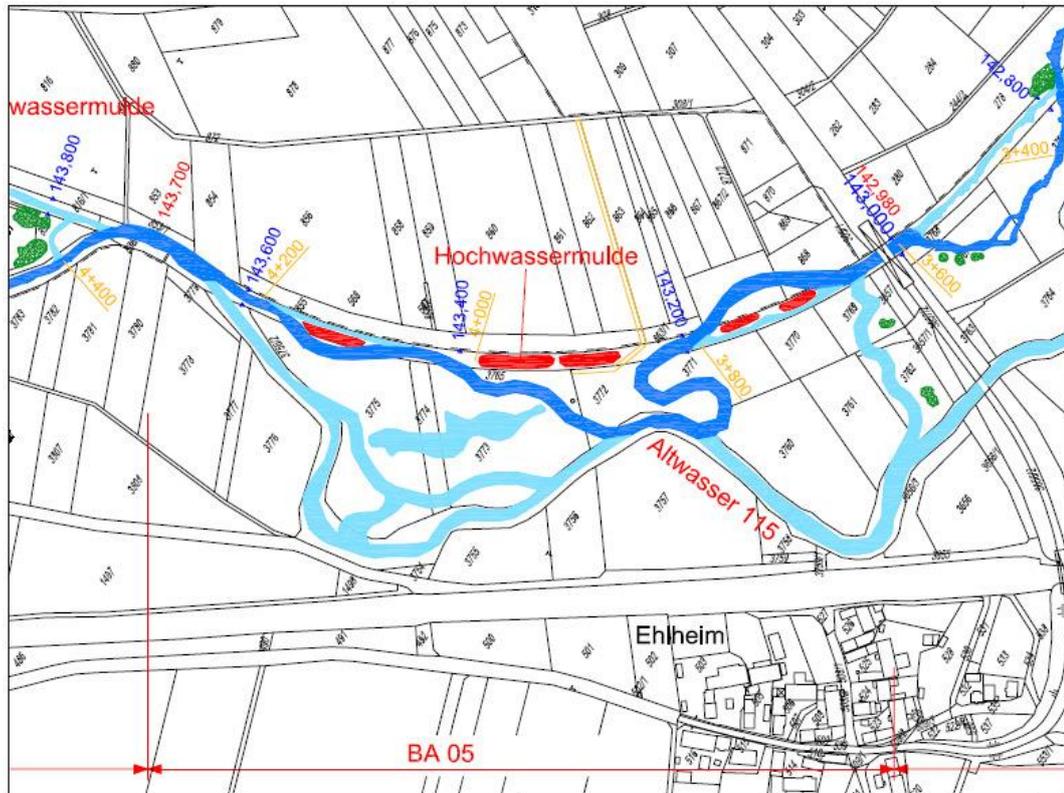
Lageplan der Umgestaltungsstrecke bei Ehlheim, Durchführung 2008 (aus WASSERWIRTSCHAFTSAMT ANSBACH 2008)
